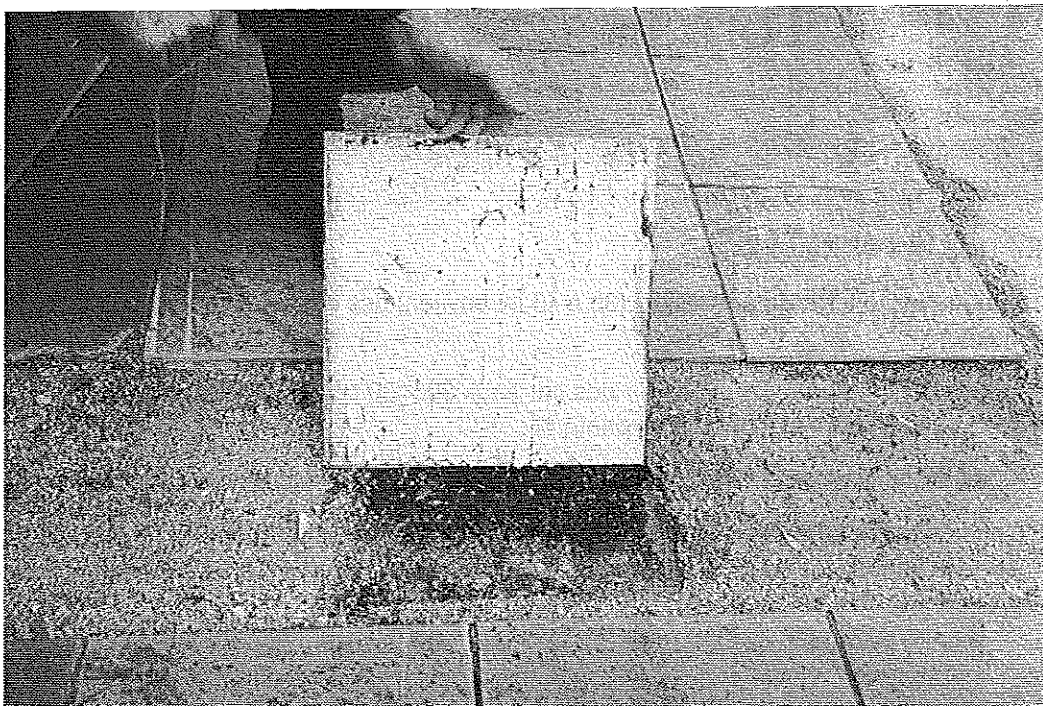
Carreau décollé. Sous-face enduite de colle. Défaut d'adhérence avec le support.
